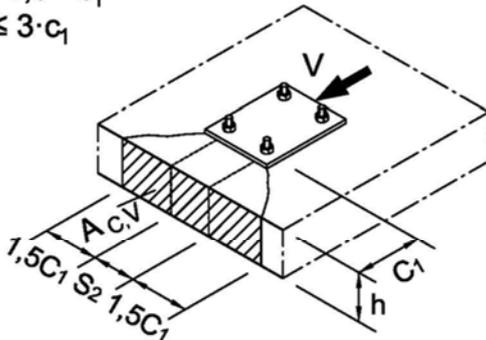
Beispiele für vorhandene Flächen der idealisierten Betonausbruchkörper für Ankerbolzensgruppen unter Querbeanspruchung
